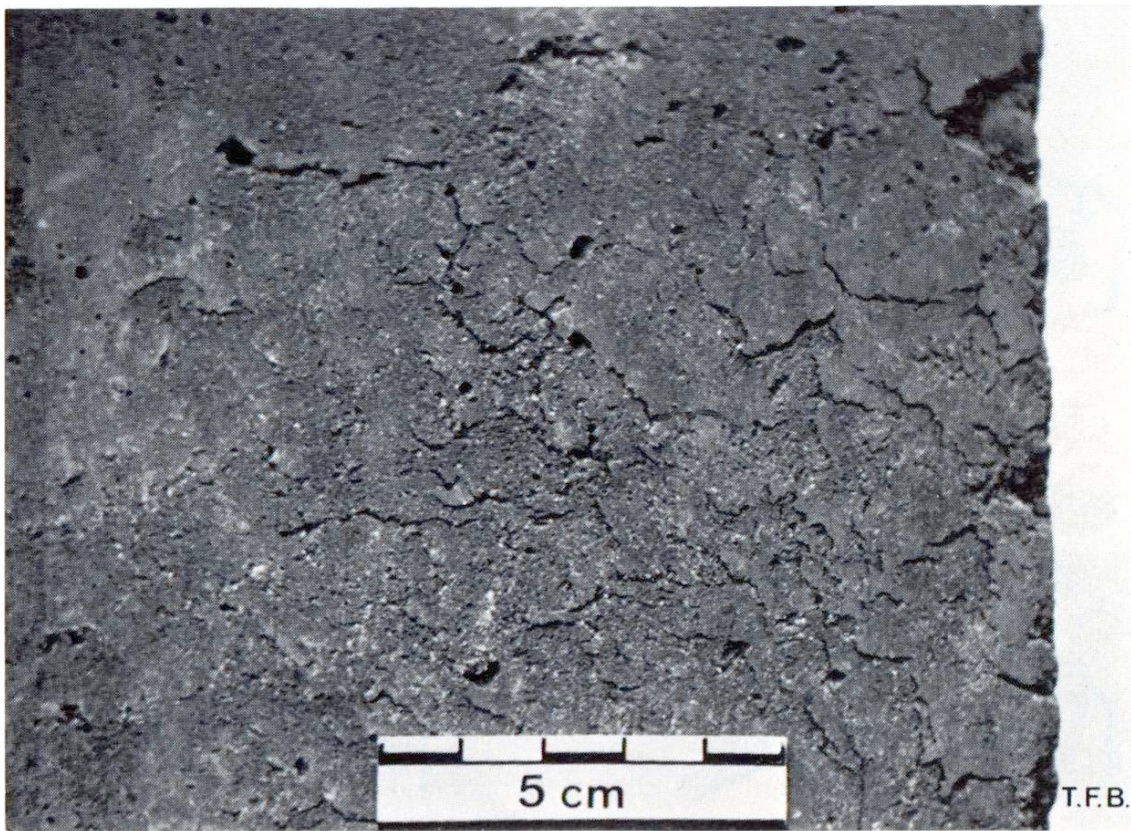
Fissures de tassement avec écaillage de la surface dues à un frottement entre coffrage et «béton jeune».
